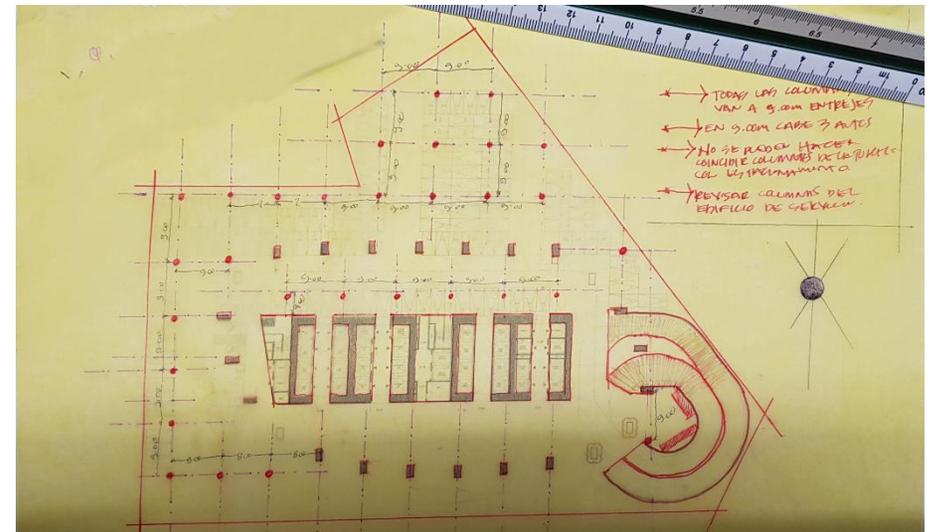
Propuesta de ubicación de columnas para estacionamiento
